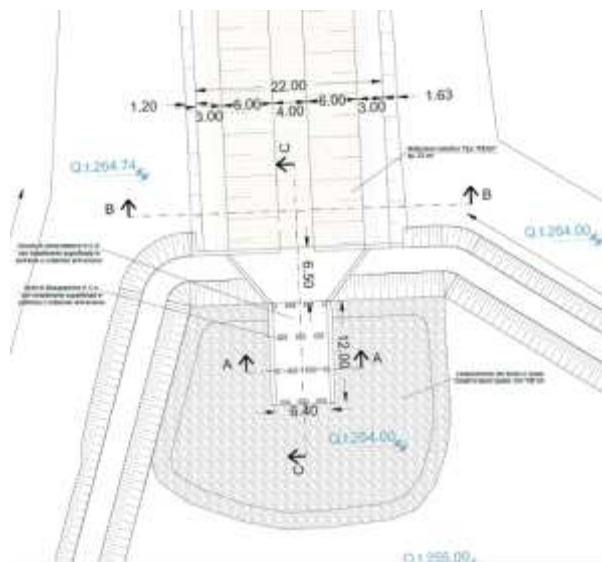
Pianta Scivolo di alimentazione in c.a. e corazzamento del fondo vasca
